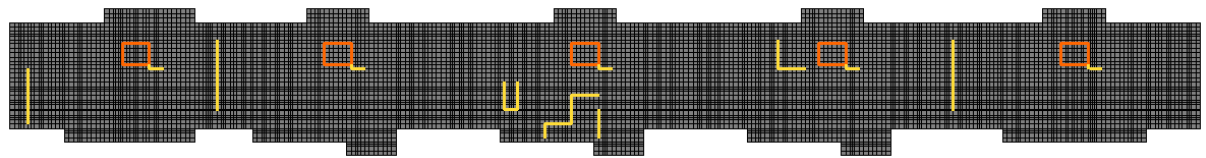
Нагрузка на фундаментную плиту от веса перегородок
